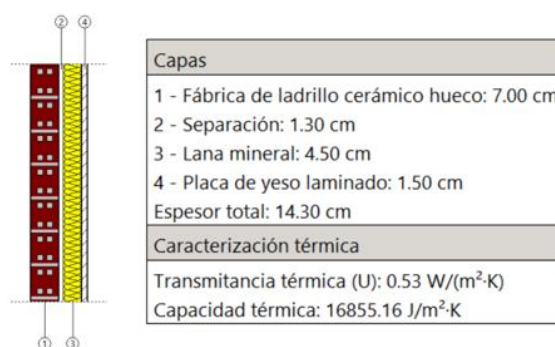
Tabiquería consta de una hoja, con trasdosado en una cara
